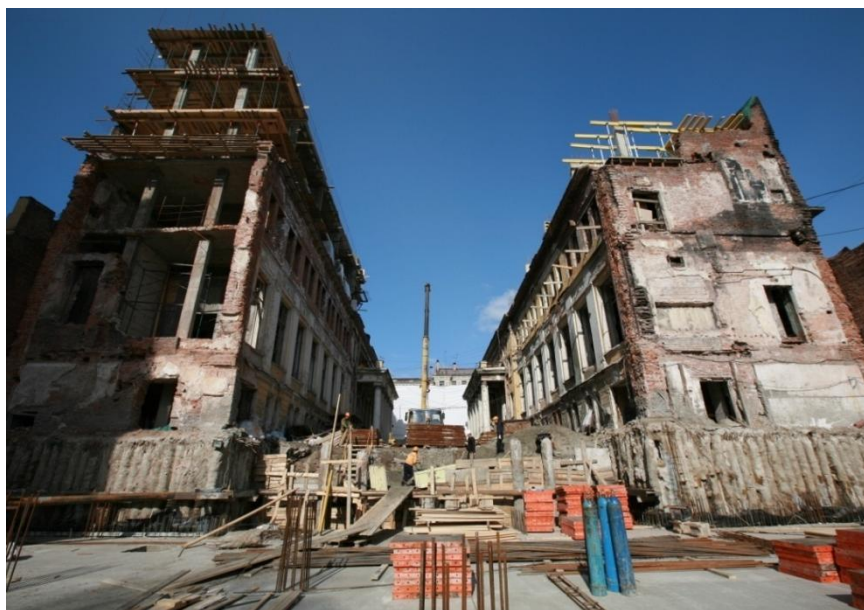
Вид площадки реконструкции здания с уровня выполненной железобетонной плиты подземного уровня.
